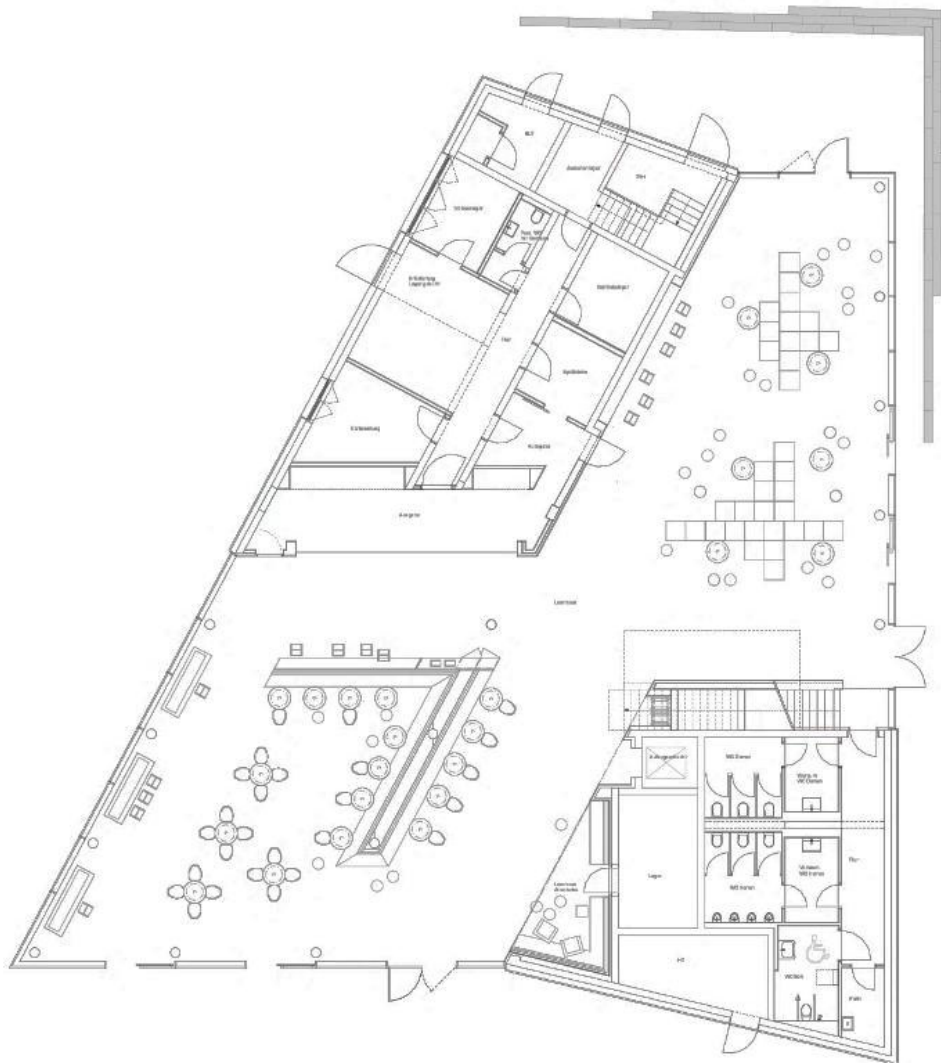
Grundriss LEO Lernort Erdgeschoss. Quelle: Atelier 30 Architekten GmbH Kassel.
